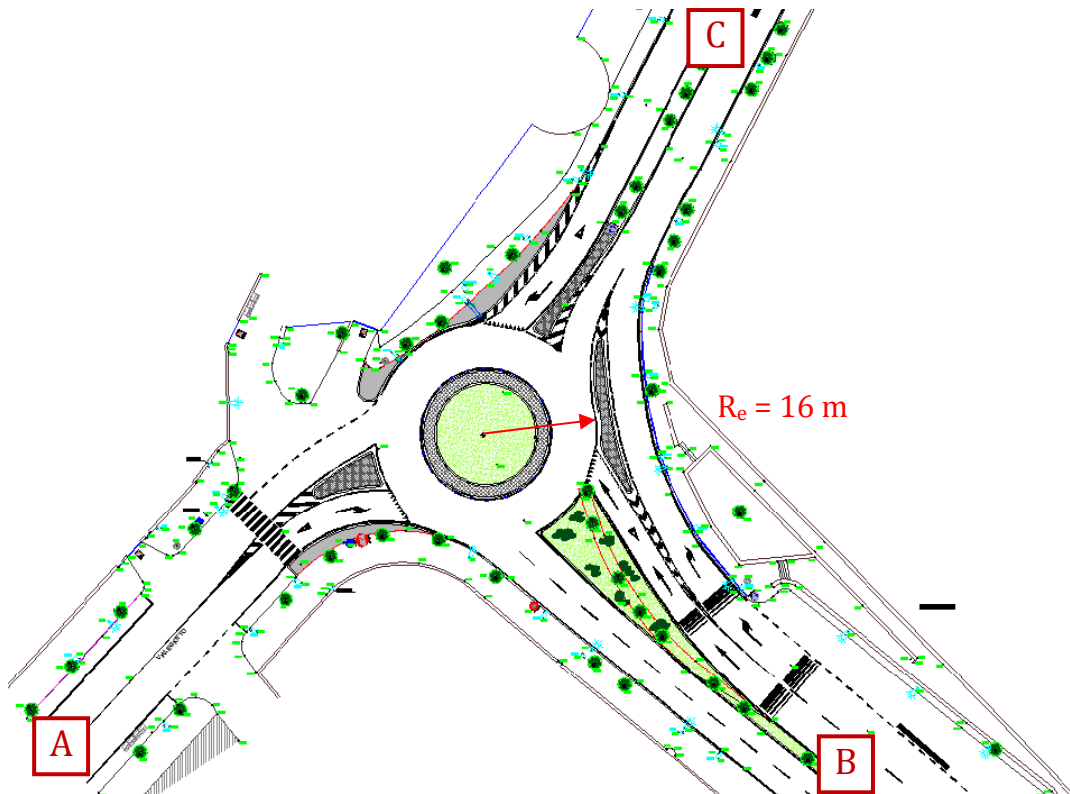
Planimetria numerica della rotatoria di viale Giotto - viale Baccelli.
